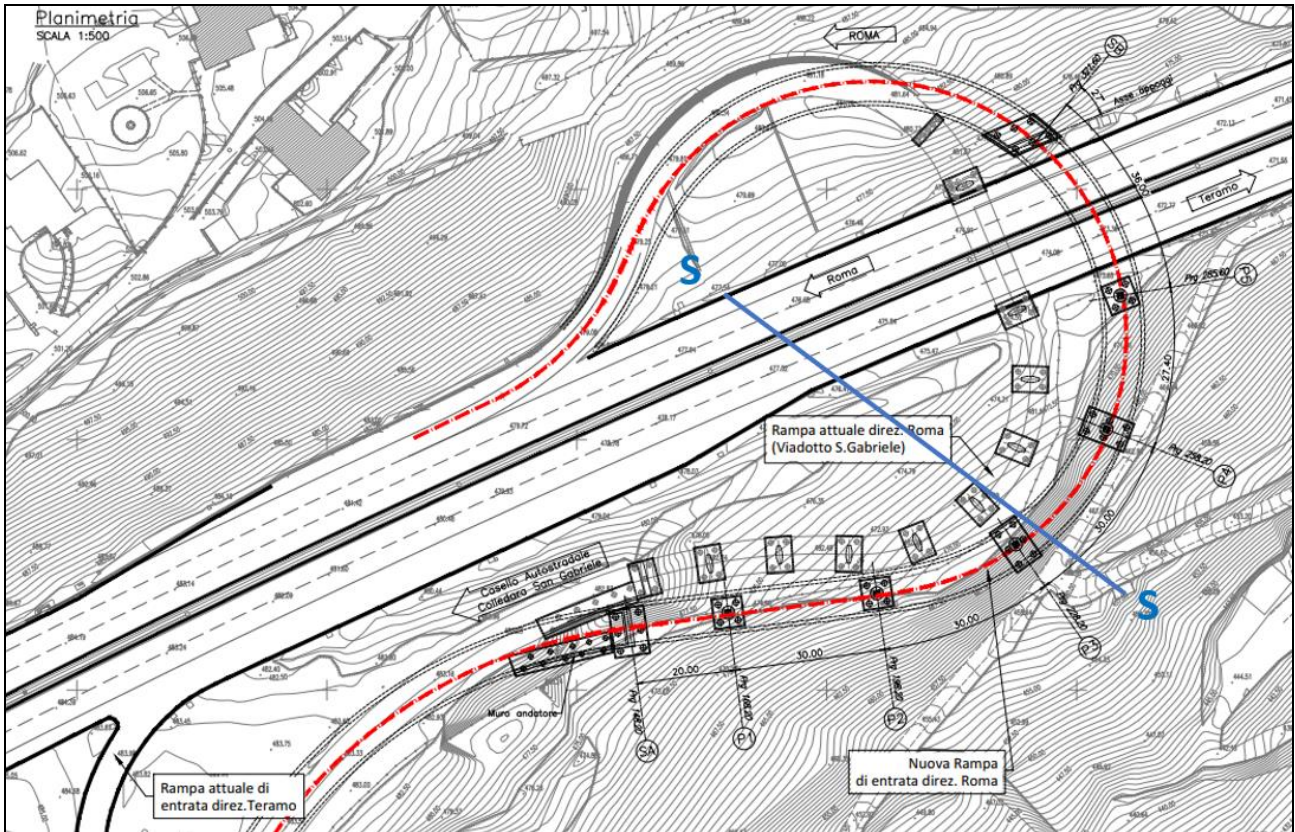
Planimetria con indicazione sezione geolitologica di riferimento
